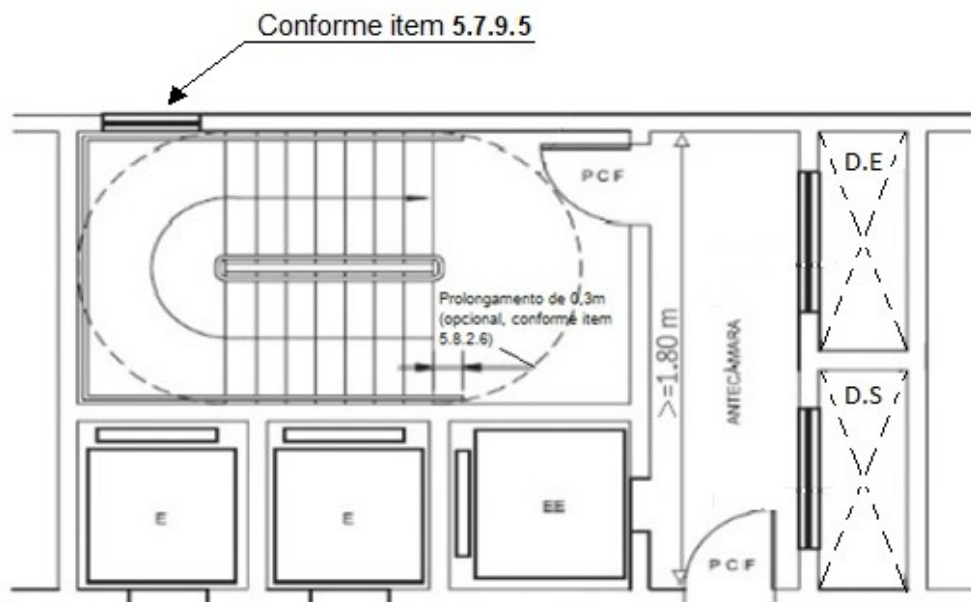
Escada enclausurada à prova de fumaça com elevador de emergência na antecâmara
